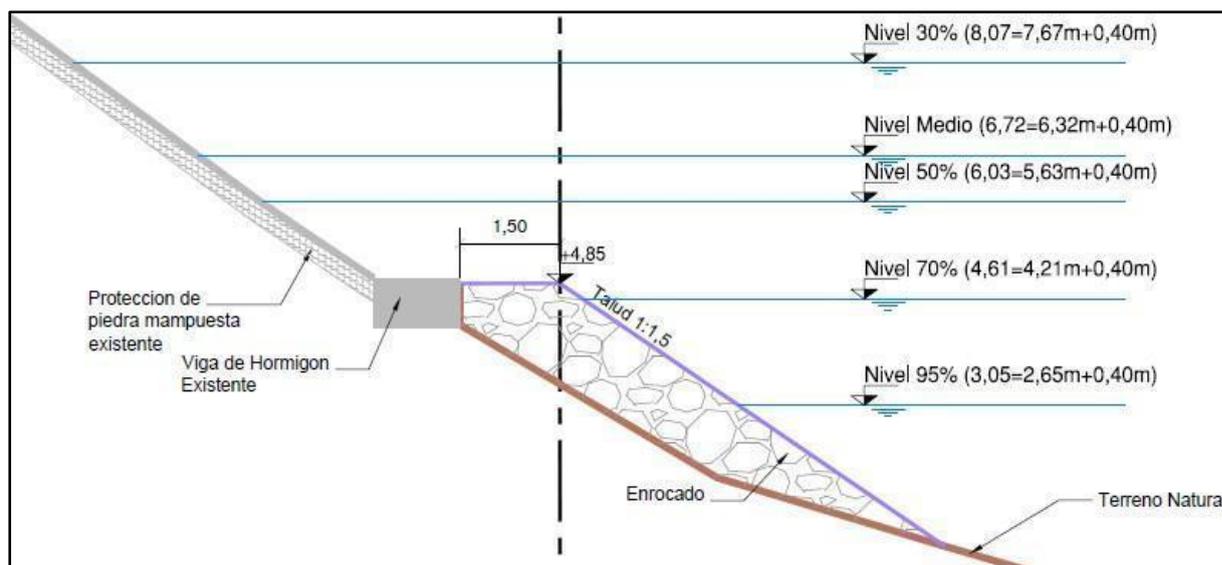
Perfil Tipo 1. Protección con enrocado de la defensa existente entre Pr. 0 a 45m
